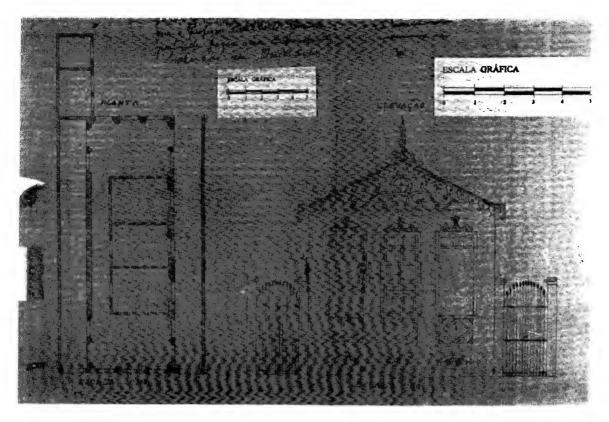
Projeto para a construção de uma casa na Cidade Balneária de Ondina, em 1898, de autor desconhecido. Fachada Principal e Planta Baixa.
